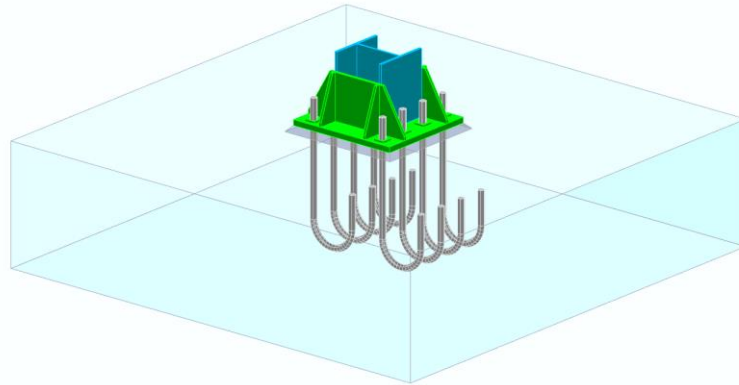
Vue 3D de l'assemblage pied de poteau
